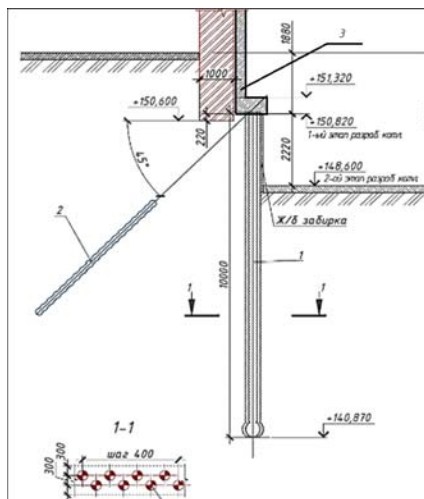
Шпунтовая стена ограждения котлована из буроинъекционных свай ЭРТ (РИТ, ЭРСТ, ФОРСТ) и грунтовых анкеров ЭРТ:
